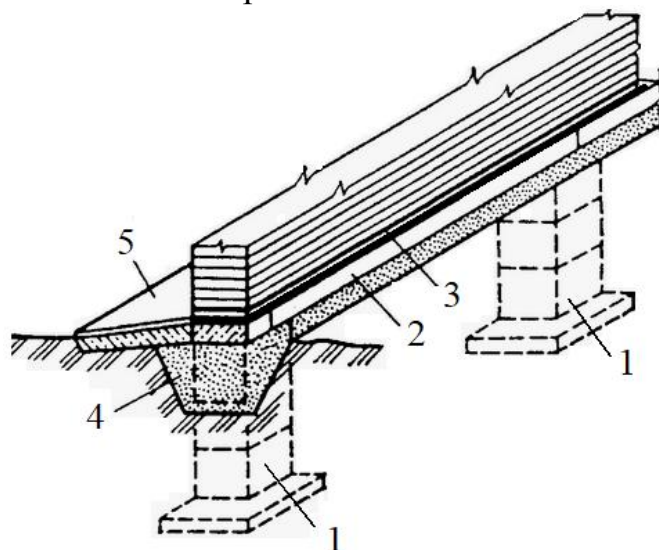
Узел опирания несущей стены здания на столбчатый фундамент
